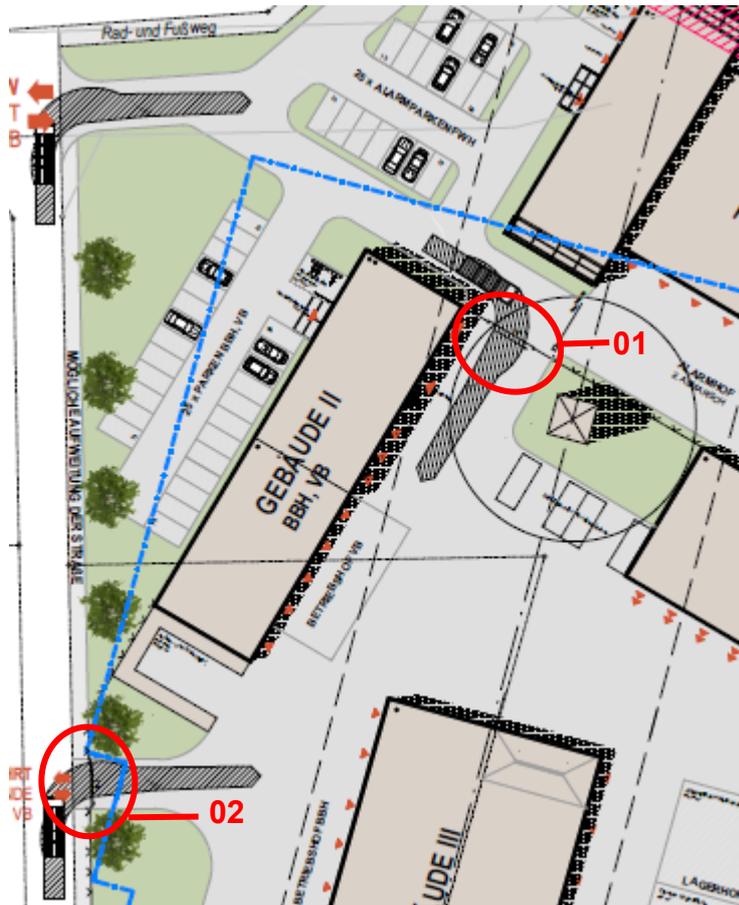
Ausschnitt Lageplan – Tor- und Schrankenanlagen
